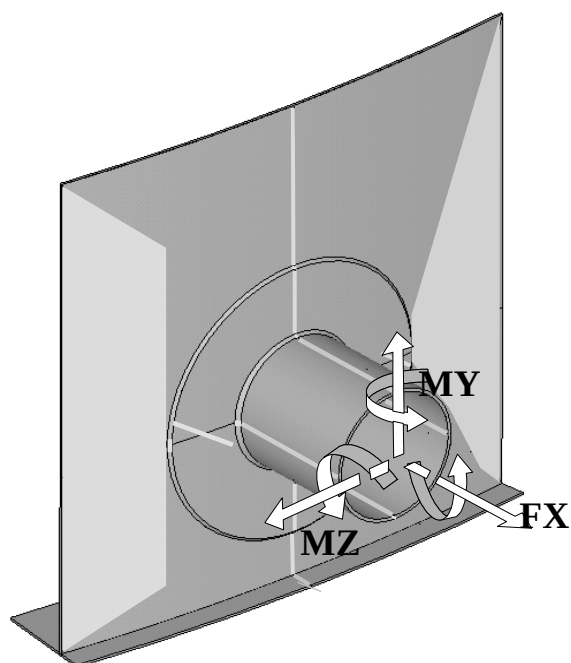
Схема приложения нагрузок на патрубков резервуара
